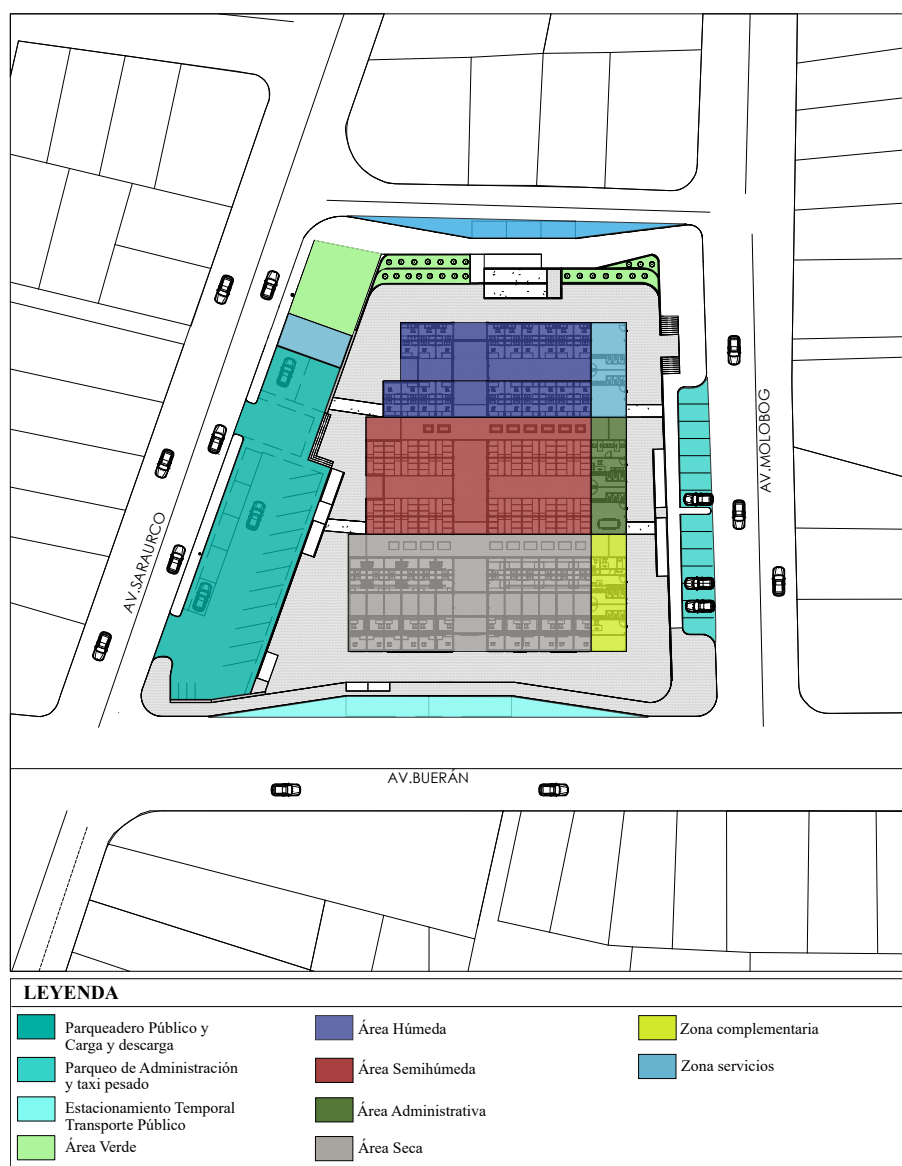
Zonificación en planta Elaboración: Propia
